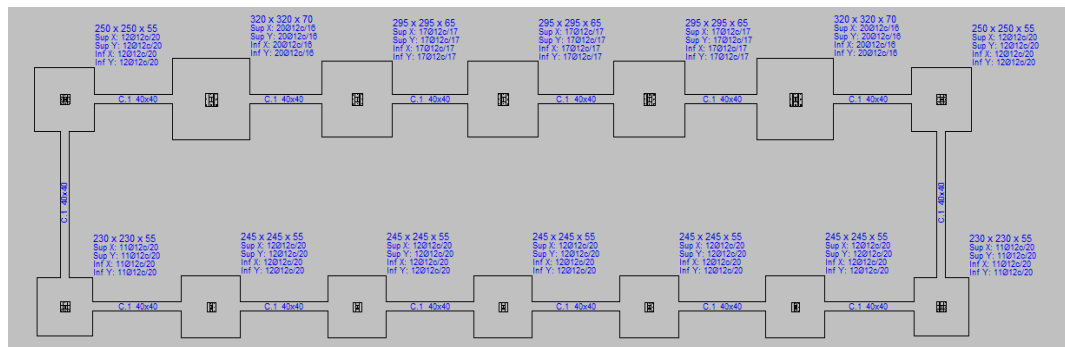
dimensionado de zapatas nave secundaria, CYPE.
